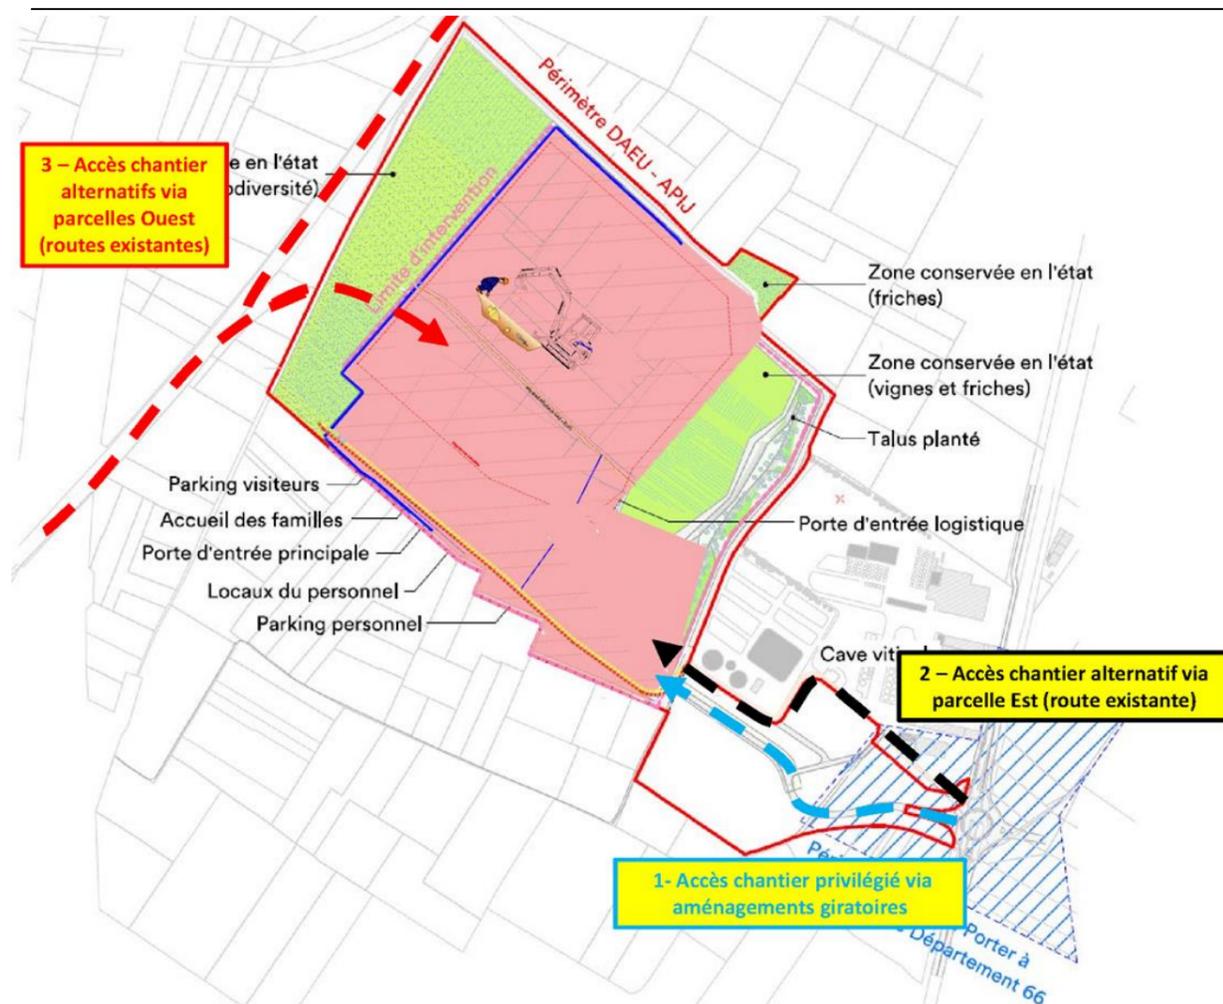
Localisation de l'accès chantier privilégié et des alternatives – plan rapproché
